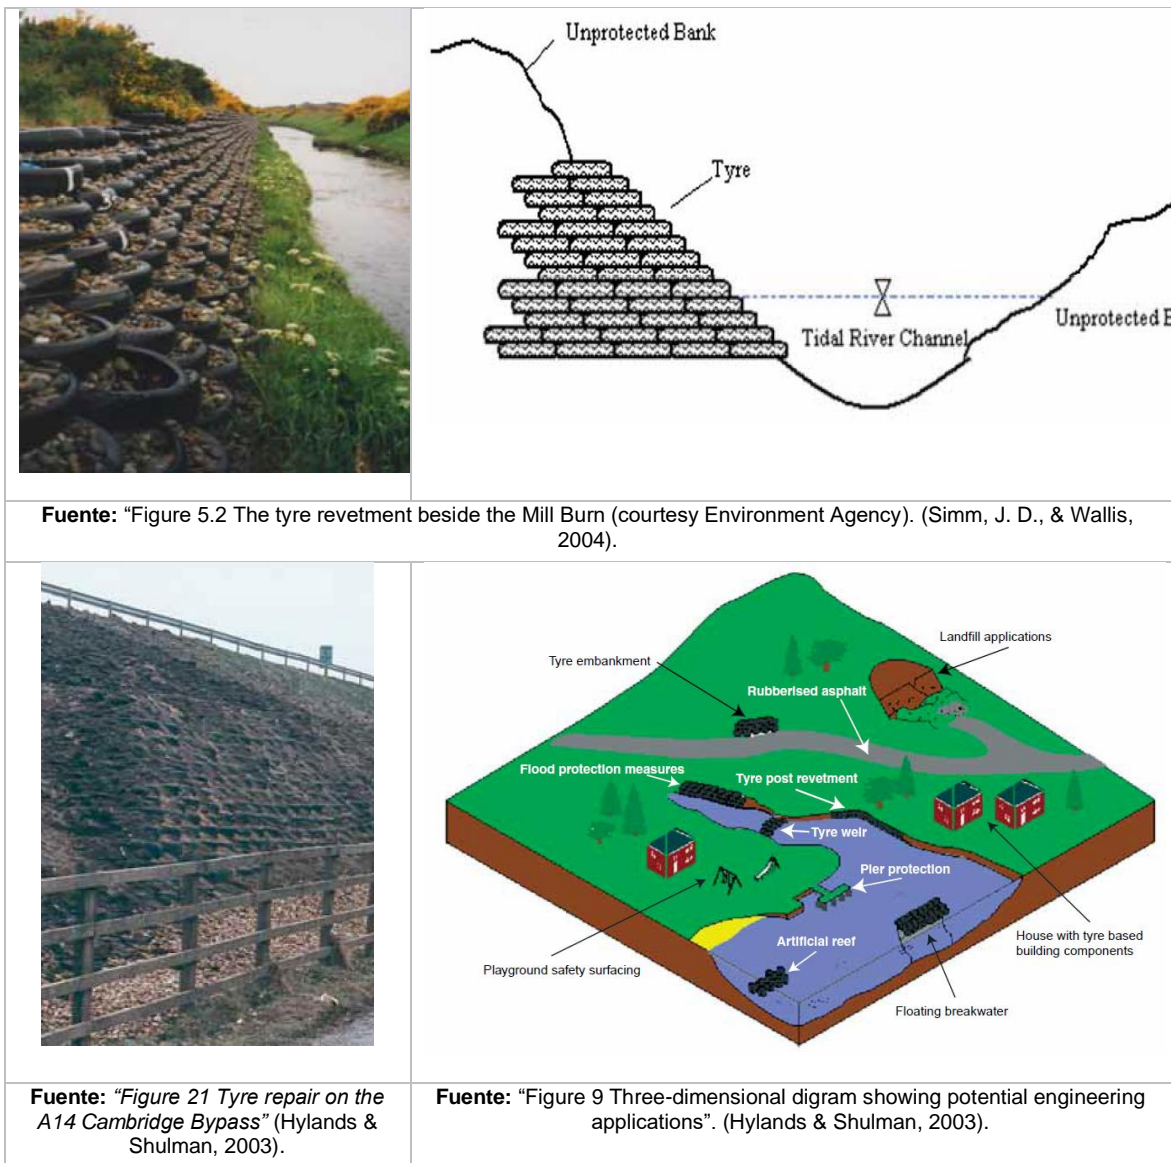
Uso en la ingeniería civil de llantas para estructuras de estabilización.
